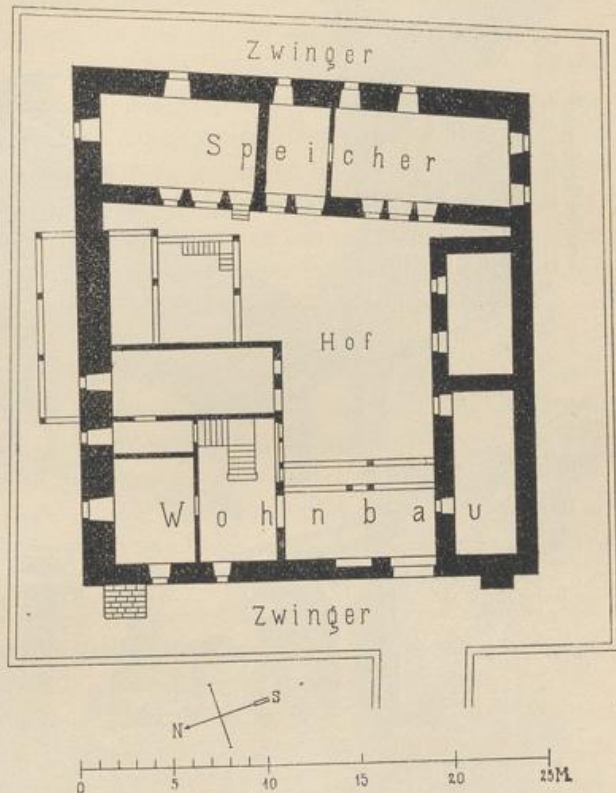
Kürnbach. Schlösschen. Grundriss des Wohnbaues.
